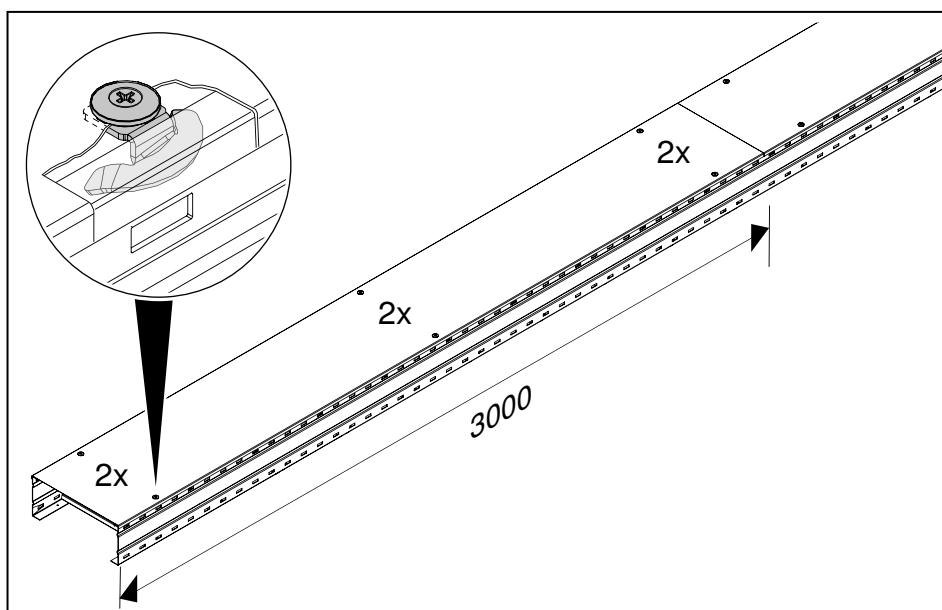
Montierter Deckel mit vormontierten Drehriegeln
